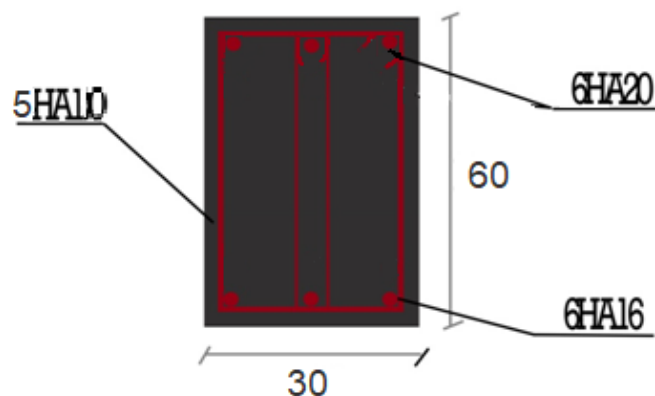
Ferrailage de poutre libage (rigide).
